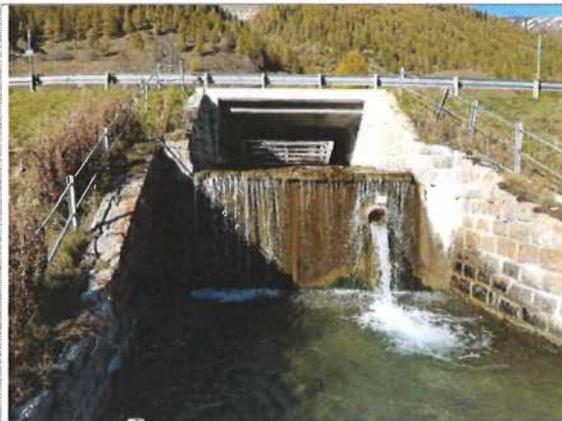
+ Abb. 5: Auslaufbauwerk Kiesfang Niderbach unterhalb Kantonsstrasse (Foto St. Walther 28.10.2010)
